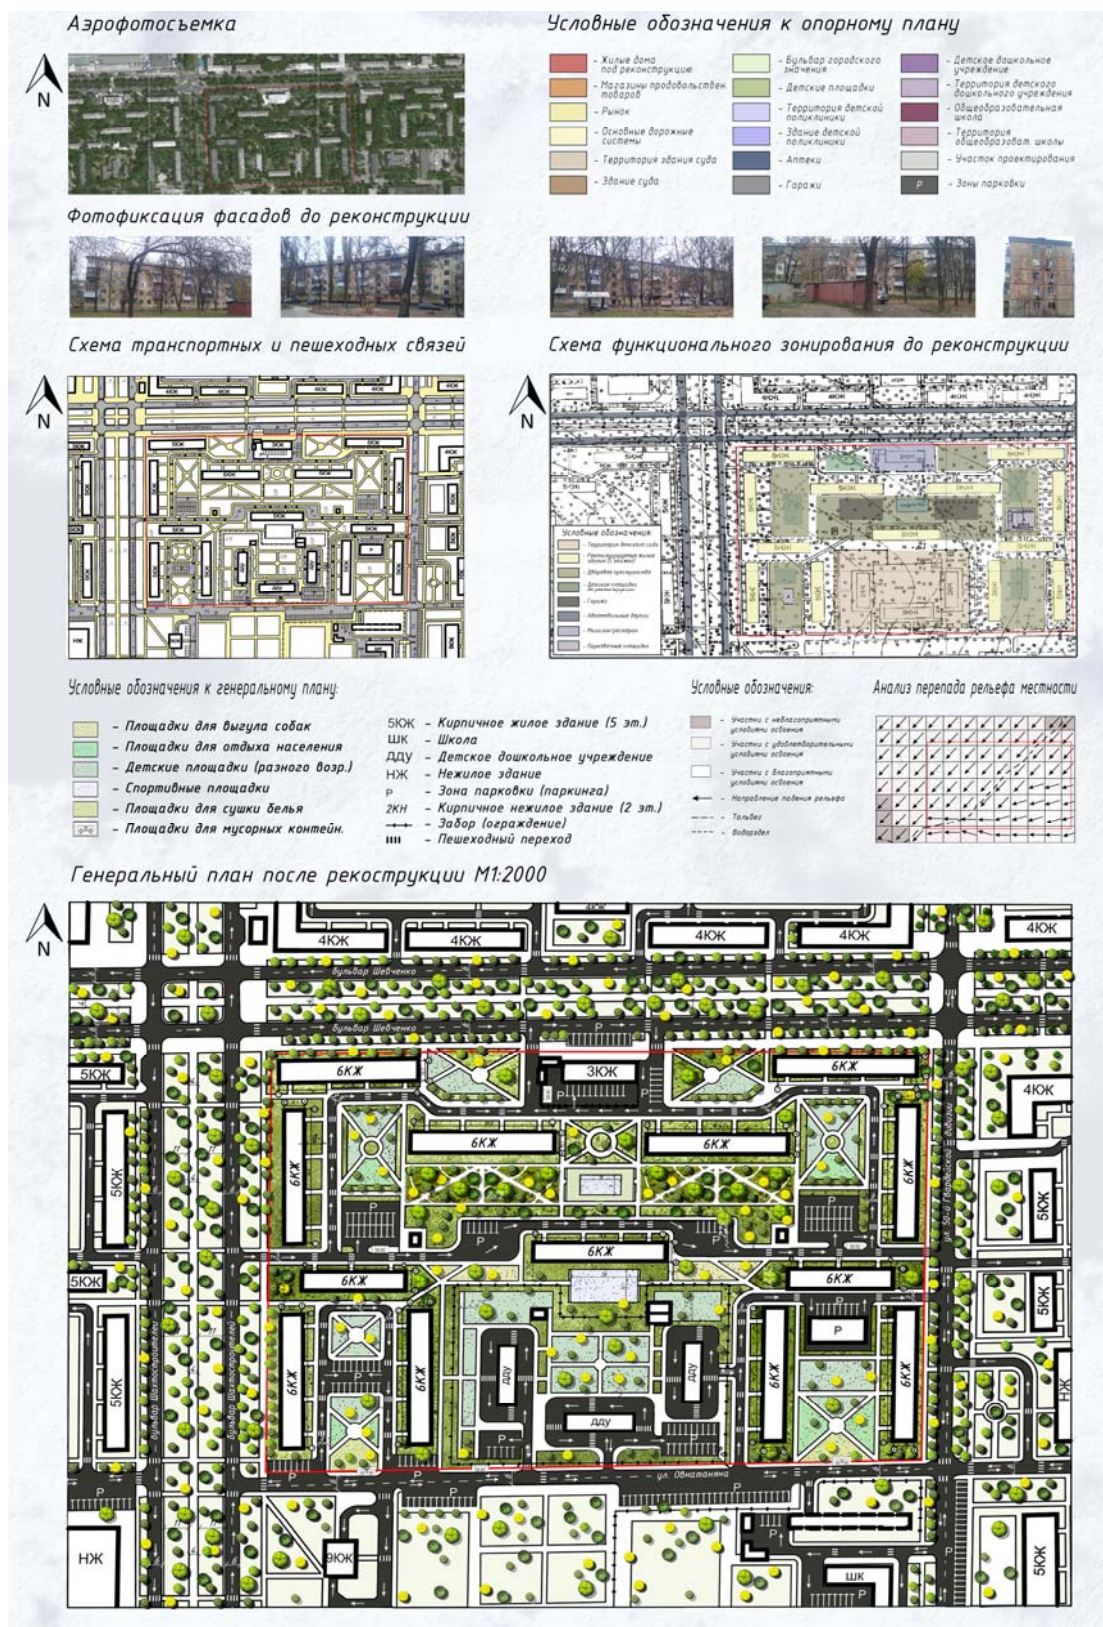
Экспериментальный проект архитектурно-градостроительной реконструкции жилого квартала в городе Донецке (градостроительное обоснование участка застройки и генеральный план после реконструкции)
